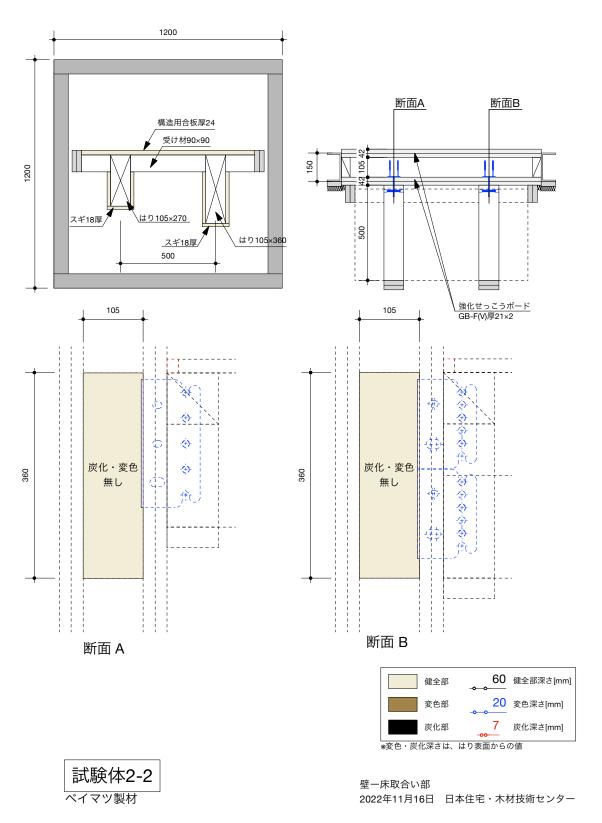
試験体 2-2 炭化図(単位:mm) ※梁受け金物を取り付けるために元々4mm 深さで座掘りされている
